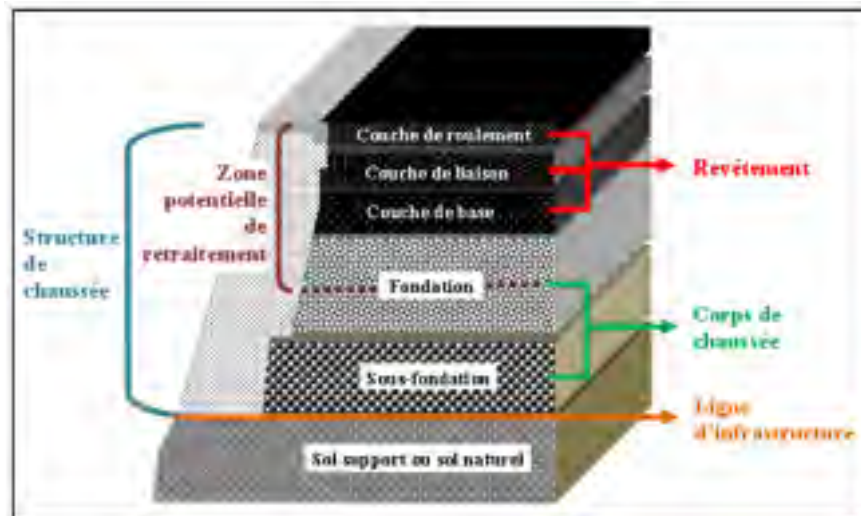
Différentes couches d'une chaussée bitumineuse au Québec
